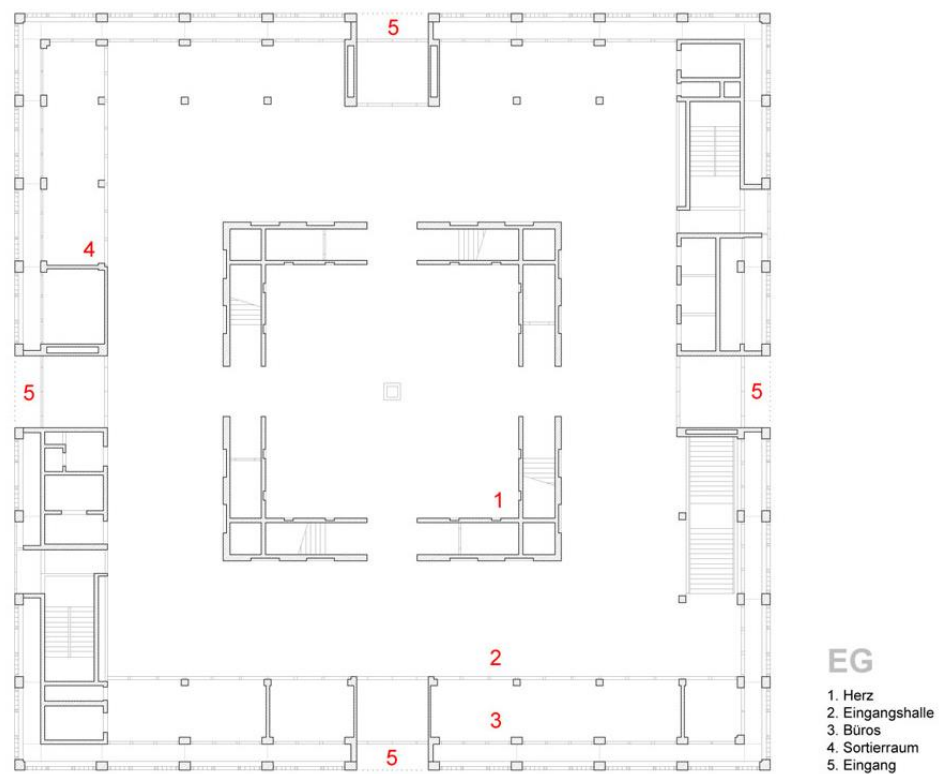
Публічна бібліотека на площі Mailänder Platz – план [13]
